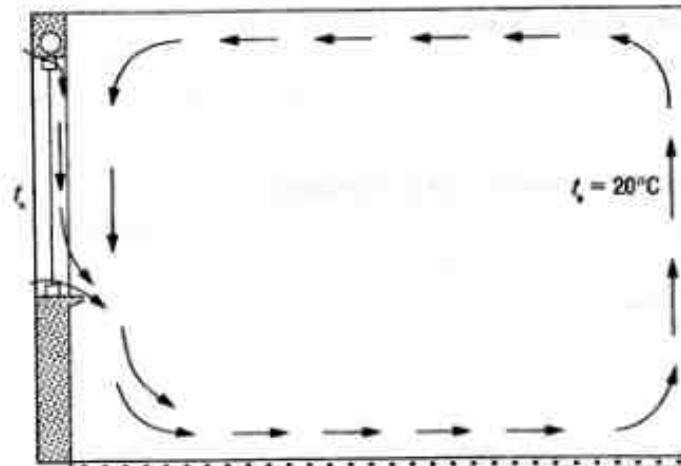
Воздушный поток в помещении с системой напольного отопления [1.4]
